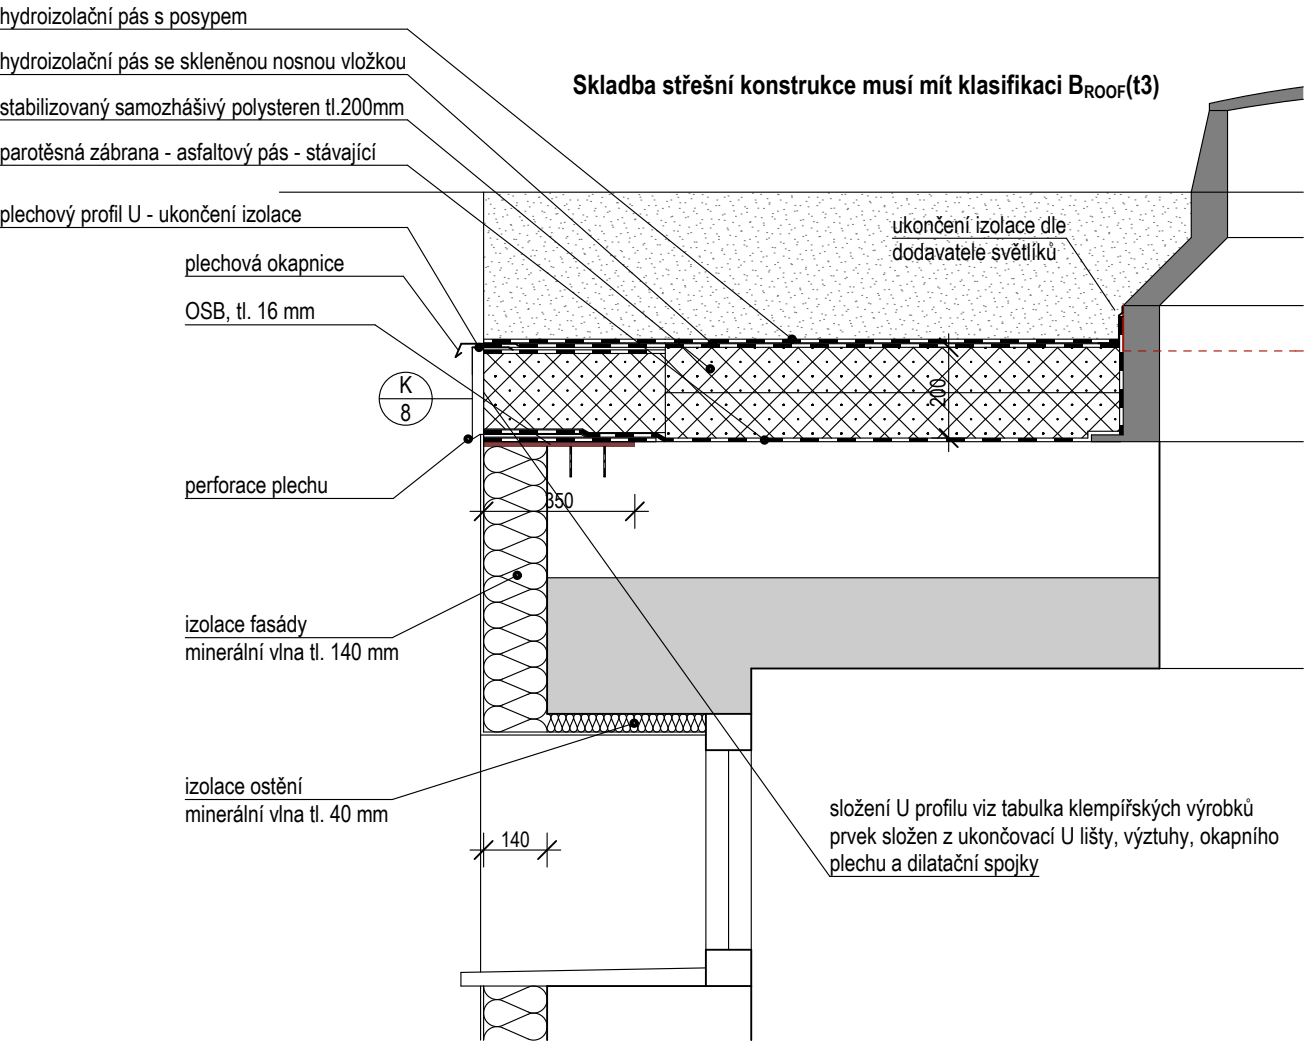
DETAIL D - NAPOJENÍ STŘECHA - PARAPET
